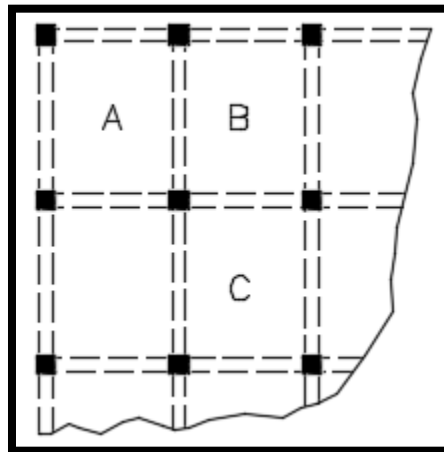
Planta de una losa de piso típica en dos direcciones con vigas en los ejes de columnas.
